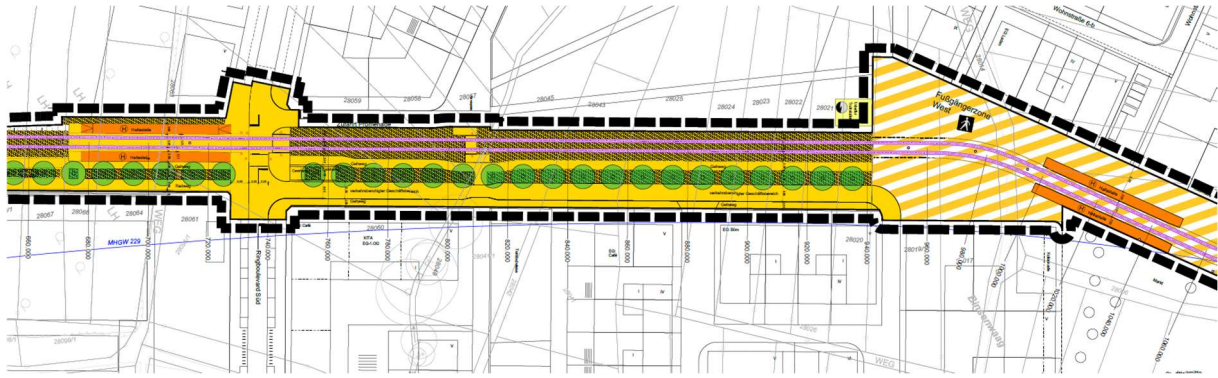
Ausschnitt aus Lageplan des B-Plans "Stadtbahn Dietenbach". In diesem Abschnitt werden vier Injektionsbrunnen realisiert.
